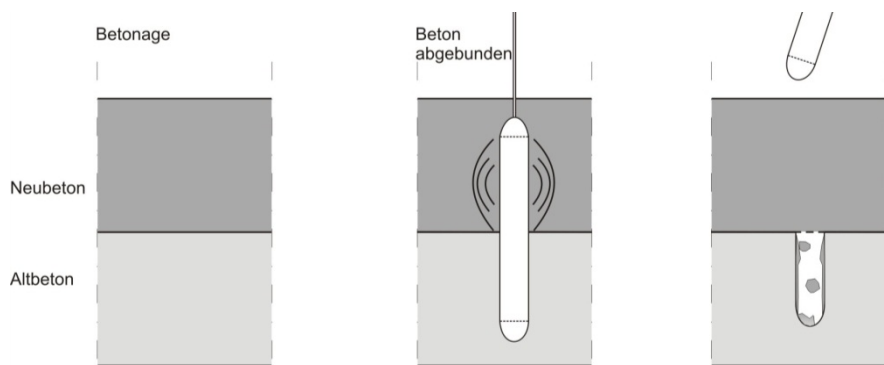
Betonage nach Erstarren des Altbetons
